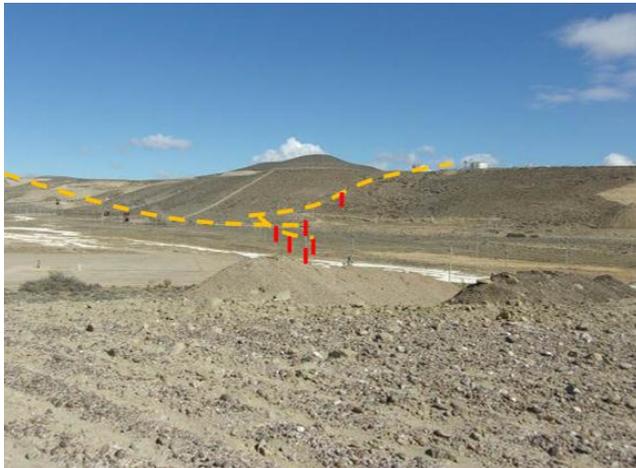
Fotografía III.C-87. Línea eléctrica (naranja) bajando hacia el cañadón. Se observan los postes (rojo). Foto en dirección Este.
